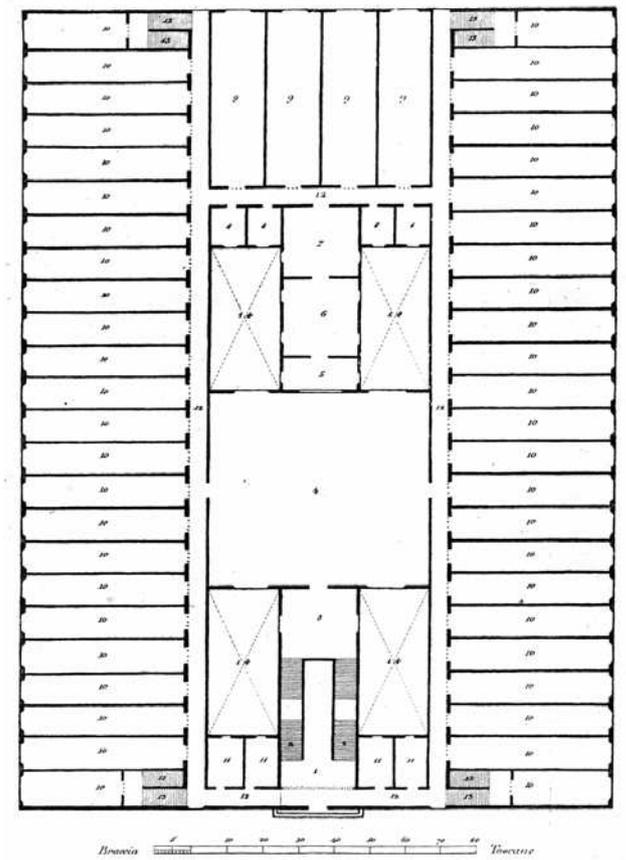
Grundriss der Demonstrationsanlage, Leopold della Santa, 1816
